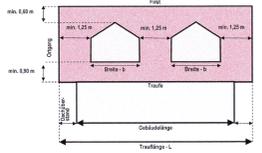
Abmessungen zulässiger Dachgauben (hier Beispiel: Satteldach)
